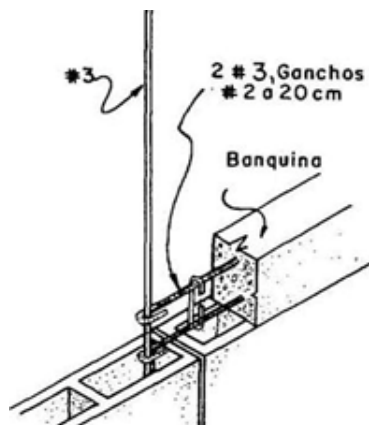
Detalle de anclaje barra de las barras longitudinales de la banda o vigueta (Moas, 1993).
